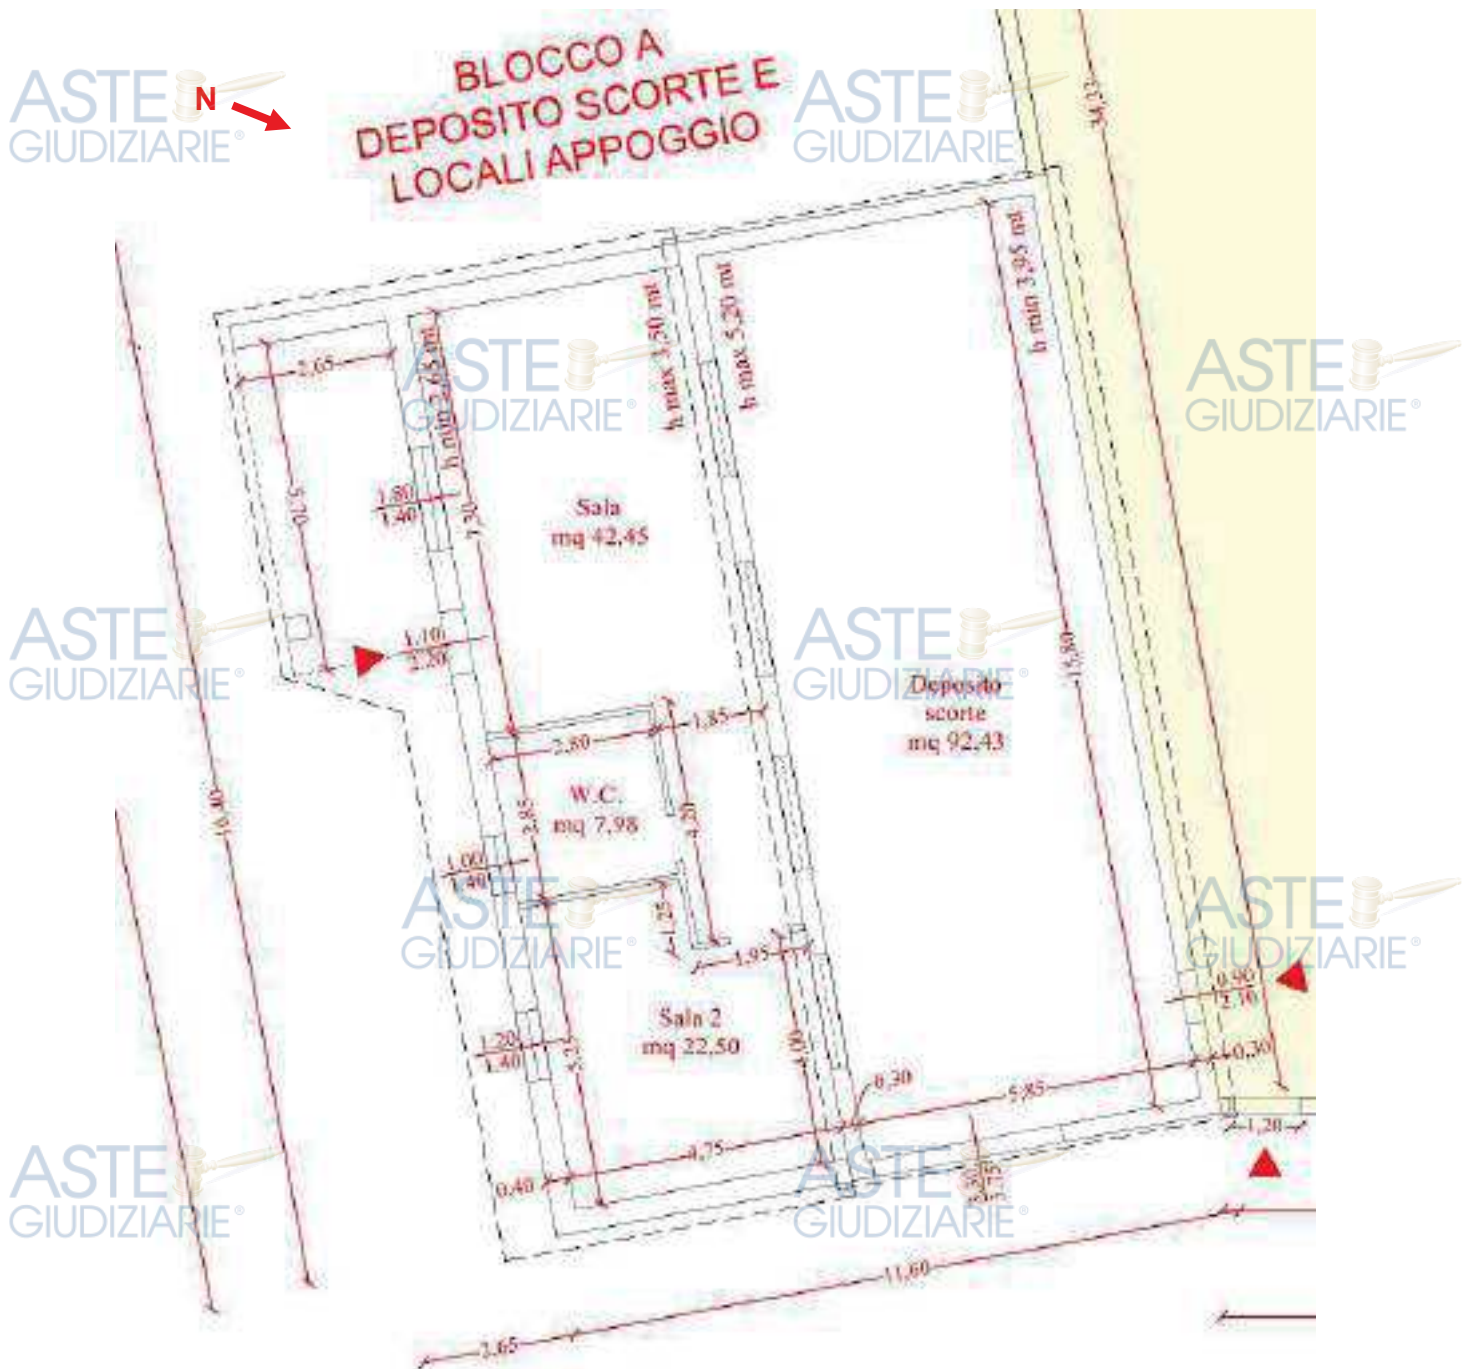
Planimetria di rilievo del Blocco A (fuori scala)
